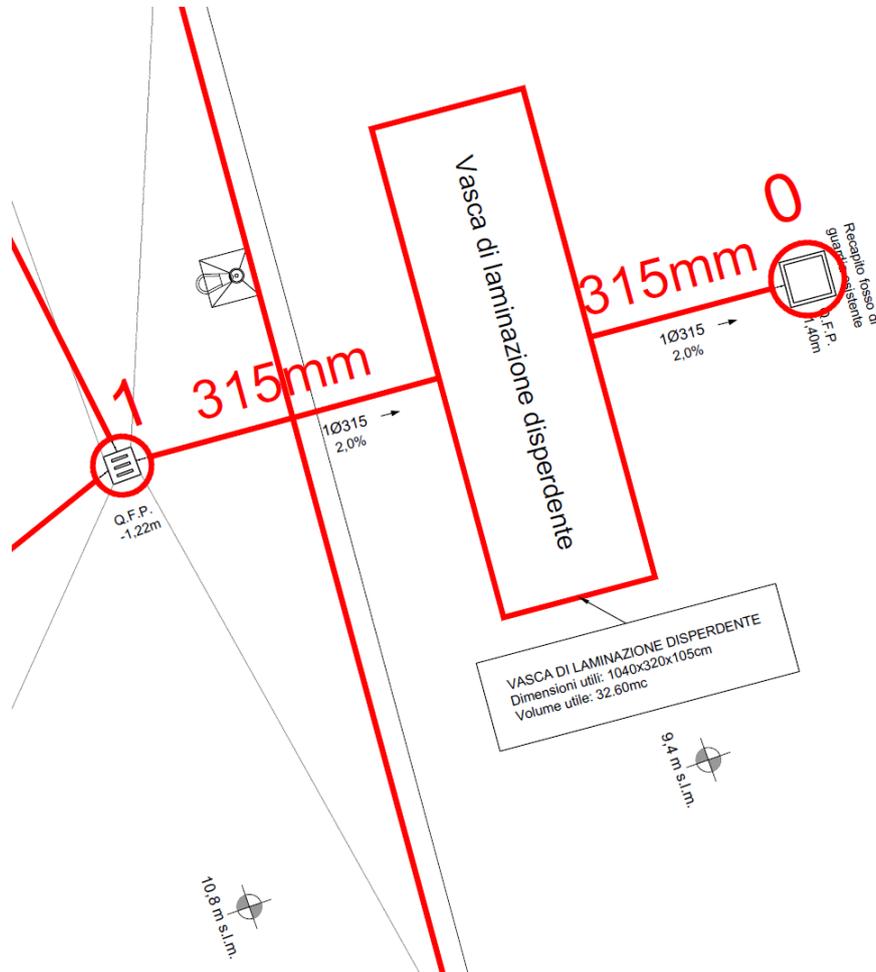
SSE Marrubiu – stralcio planimetrico della vasca disperdente, condotta di by-pass e pozzetto di recapito
